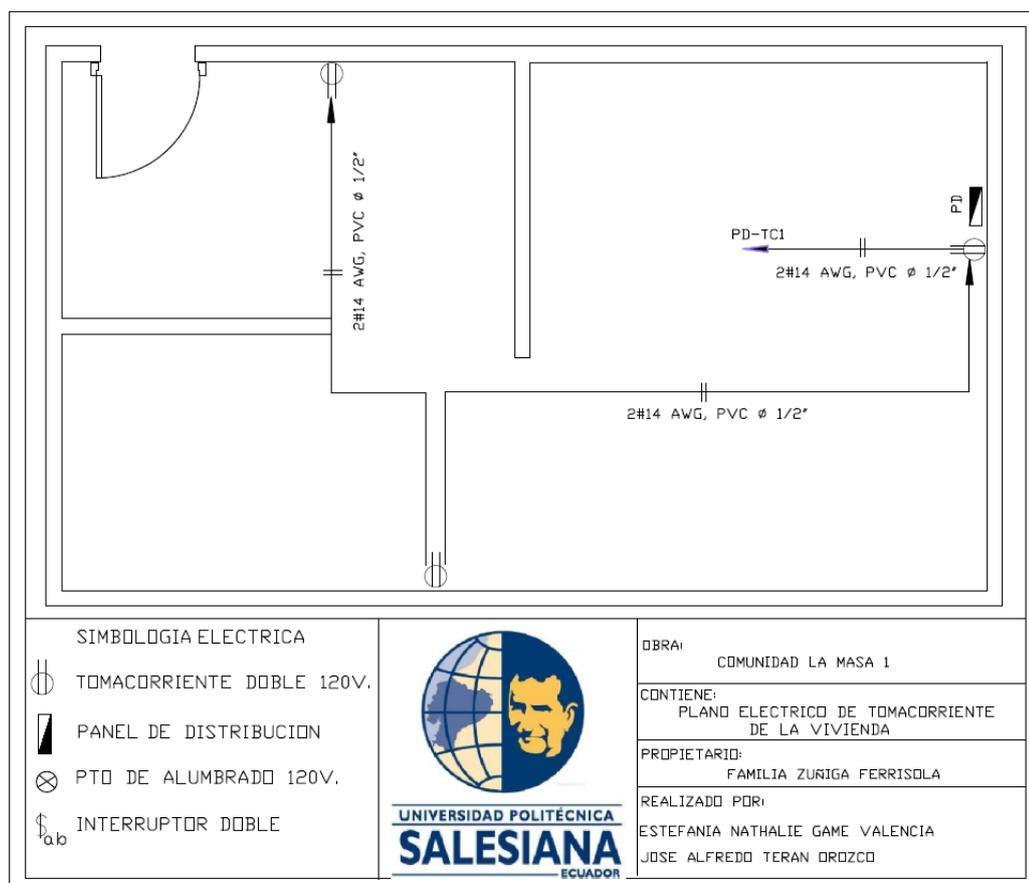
Plano eléctrico de tomacorrientes de la vivienda (Fuente: Autores).
